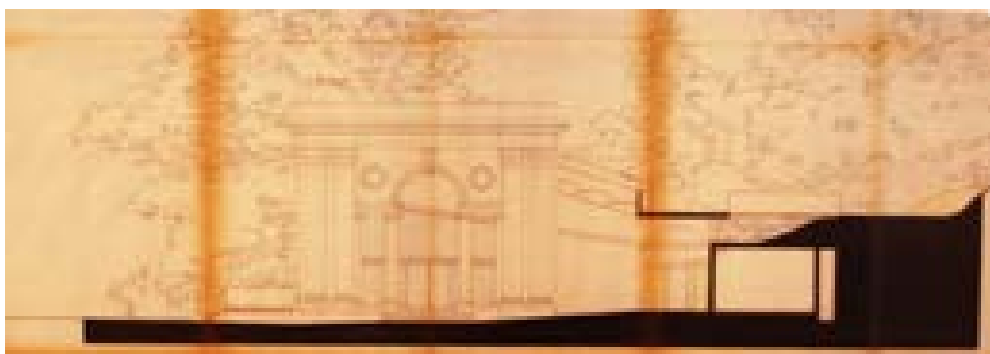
Prospetto Est, stato sovrapposto - Progetto del 15/07/1985, agg. del 15/01/1987 (AABS-150)
